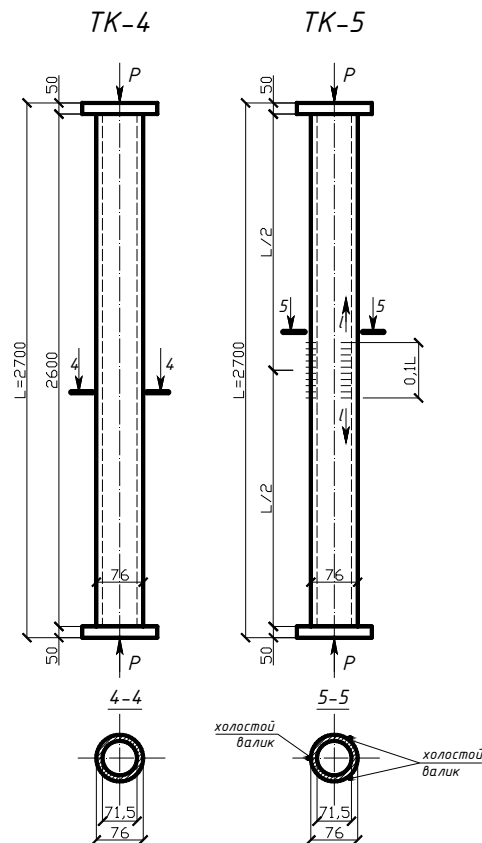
Конструкции образцов серий ТК-4 – ТК-5 с указанием мест приложения силы и наплавки холодных сварных швов:
